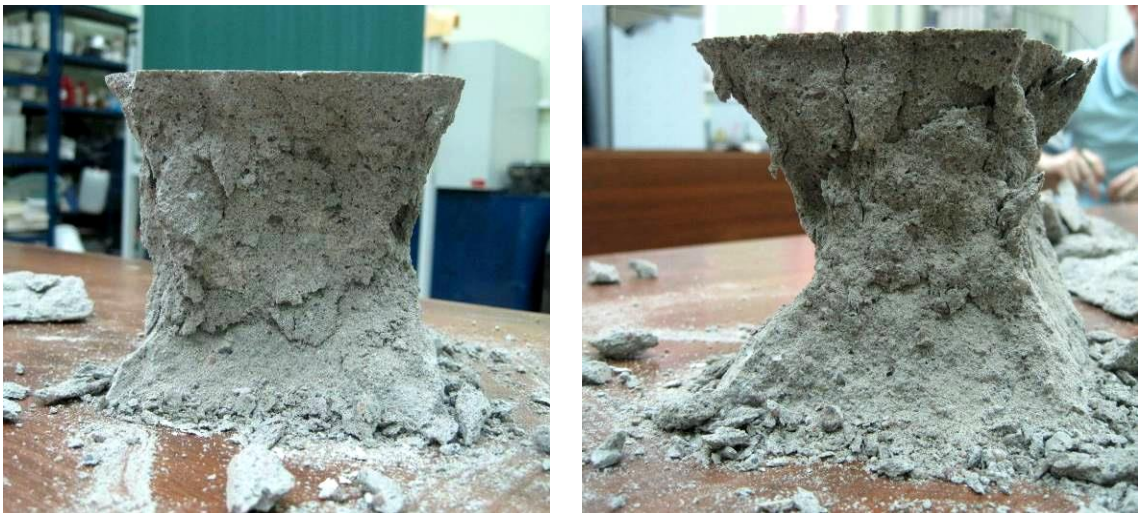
Бетонные кубы после испытания на сжатие
